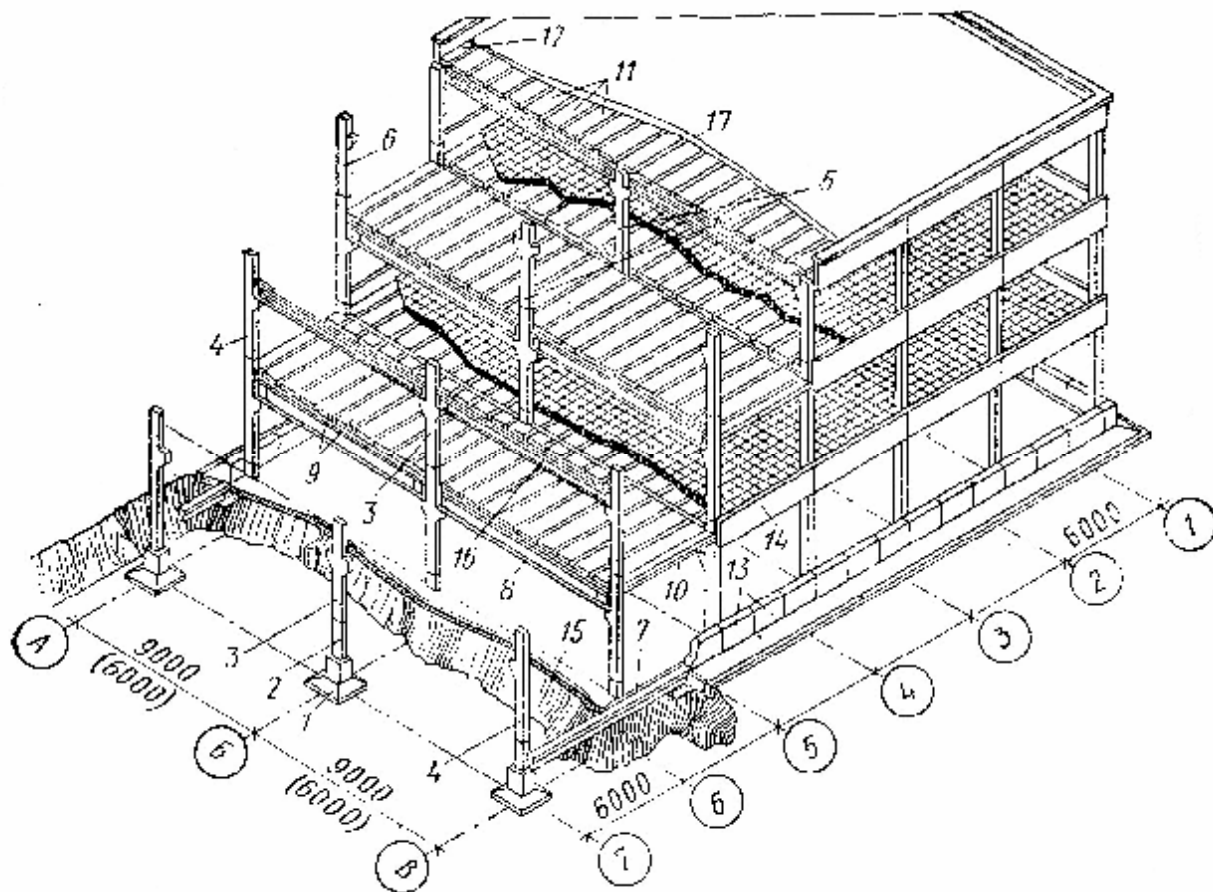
Многоэтажное производственное здание с балочными перекрытиями:
